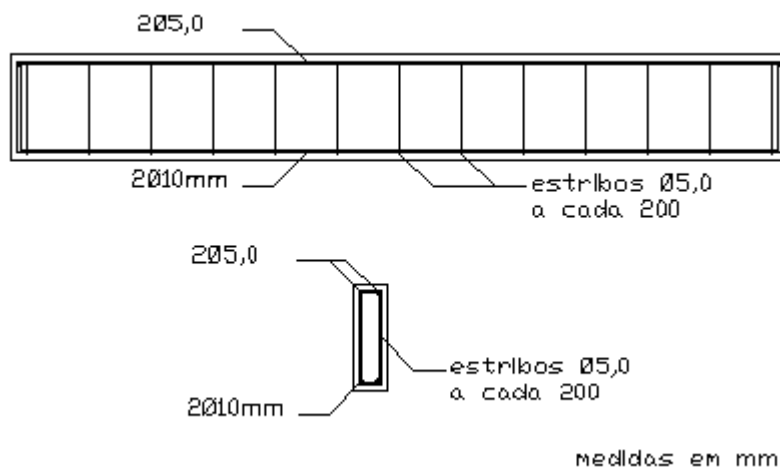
Detalhe da armadura das vigas VMI e VPF7
